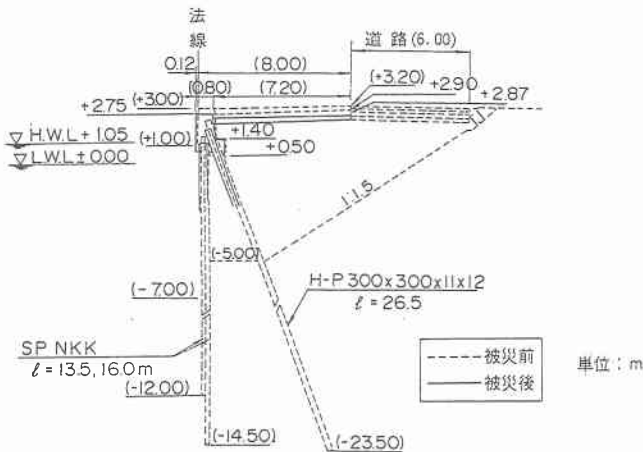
函館港北埠頭 B 岸壁 (-5.5 m) 被災断面図
